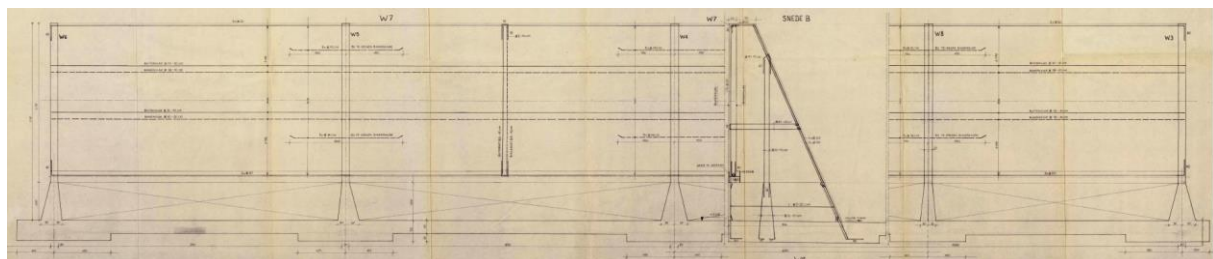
Uitsnede uit plan reeds aanwezige funderingen (bron: opdrachtgever).
